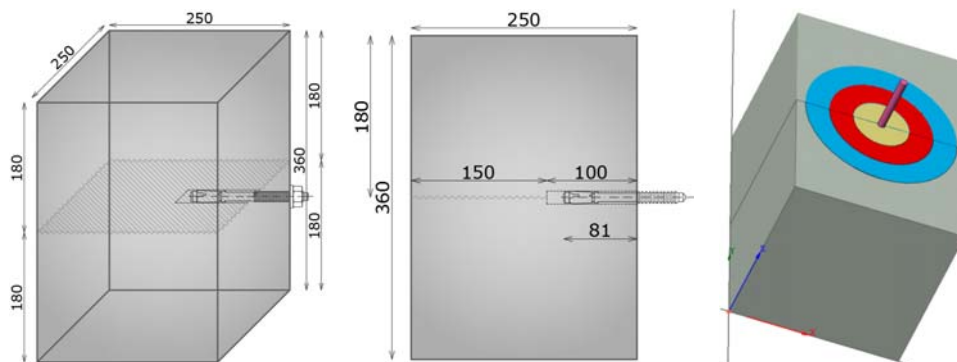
Gjeometria e kampionit të betonit të përdorur për modelin numerik.
